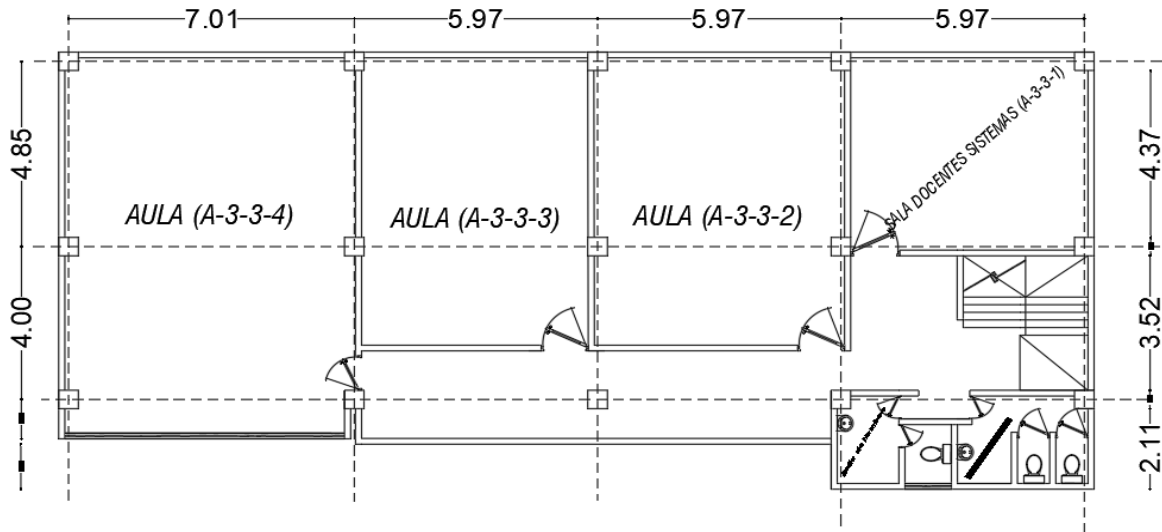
Segunda planta alta del bloque 3, donde se detalla el ámbito y codificación y se realizó un levantamiento de las dimensiones del piso.
